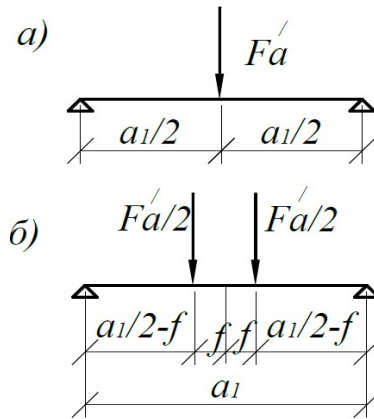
К расчету анкерных плиток: а - с одним фундаментным болтом, б - с двумя болтами
